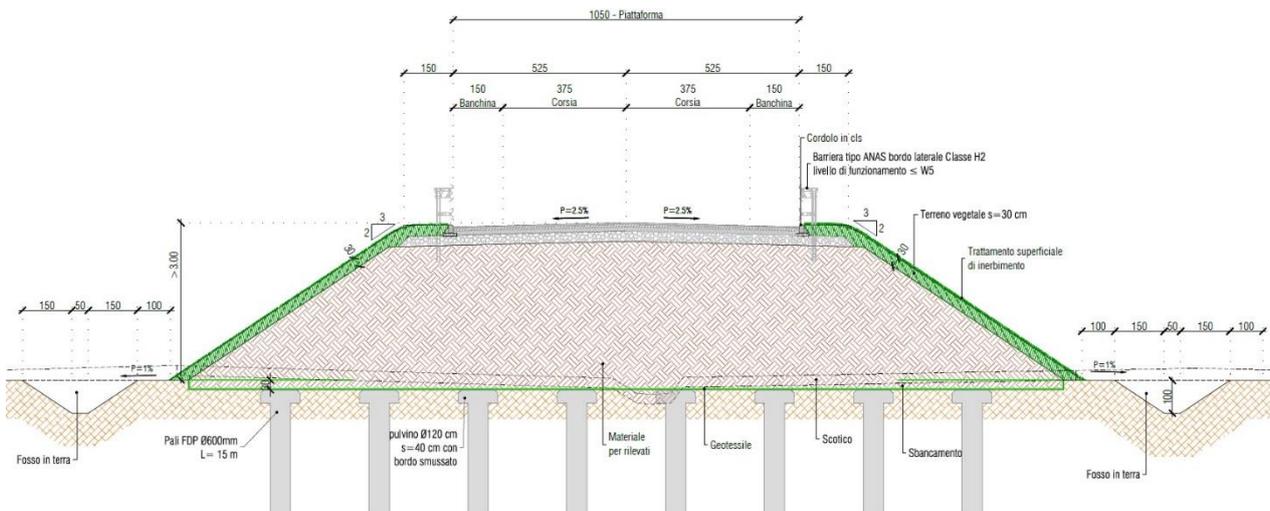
SEZIONE TIPO DI PROGETTO VARIANTE "ARMELLINA" PER RILEVATI ALTI
